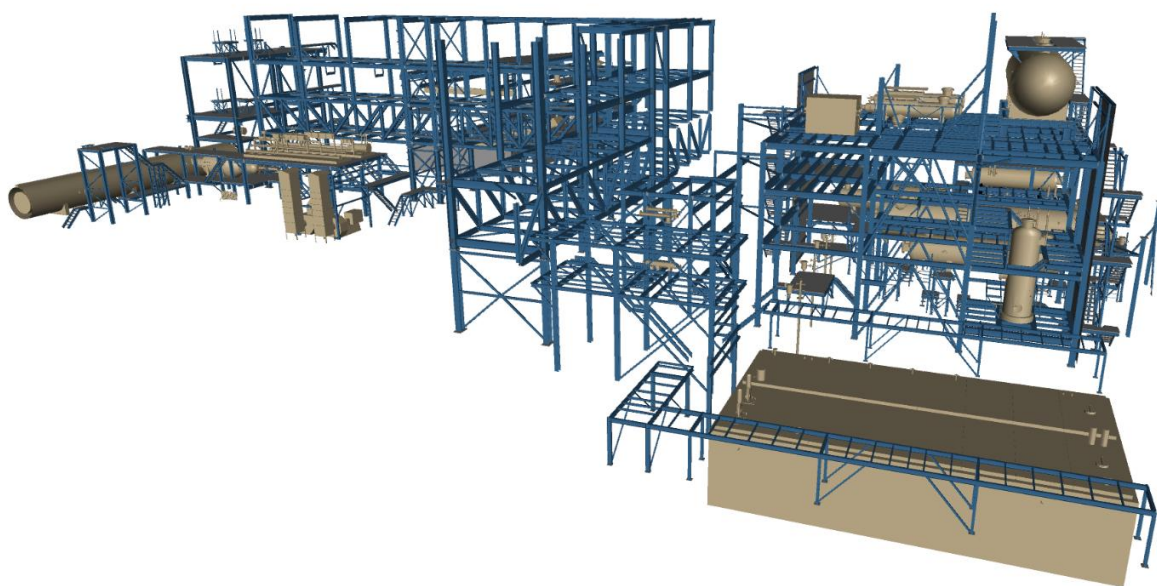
Начальное размещение ЕО и необходимых строительных конструкций схемы установки производства элементарной серы
